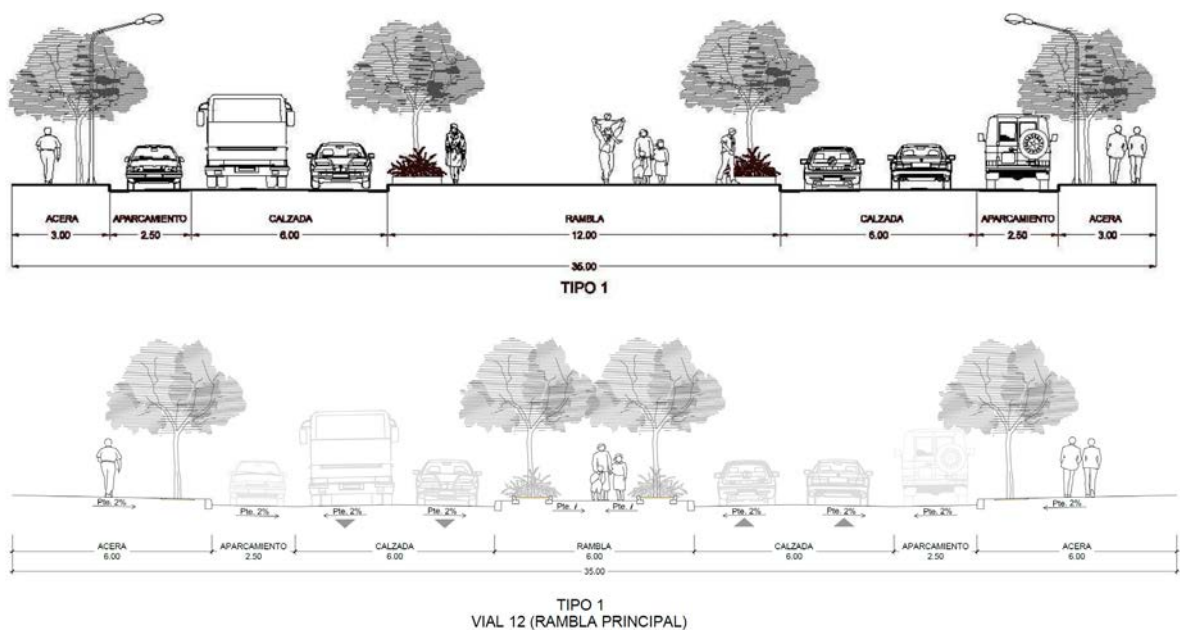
Sección de la vía estructurante según el Plan Parcial y el proyecto de urbanización
